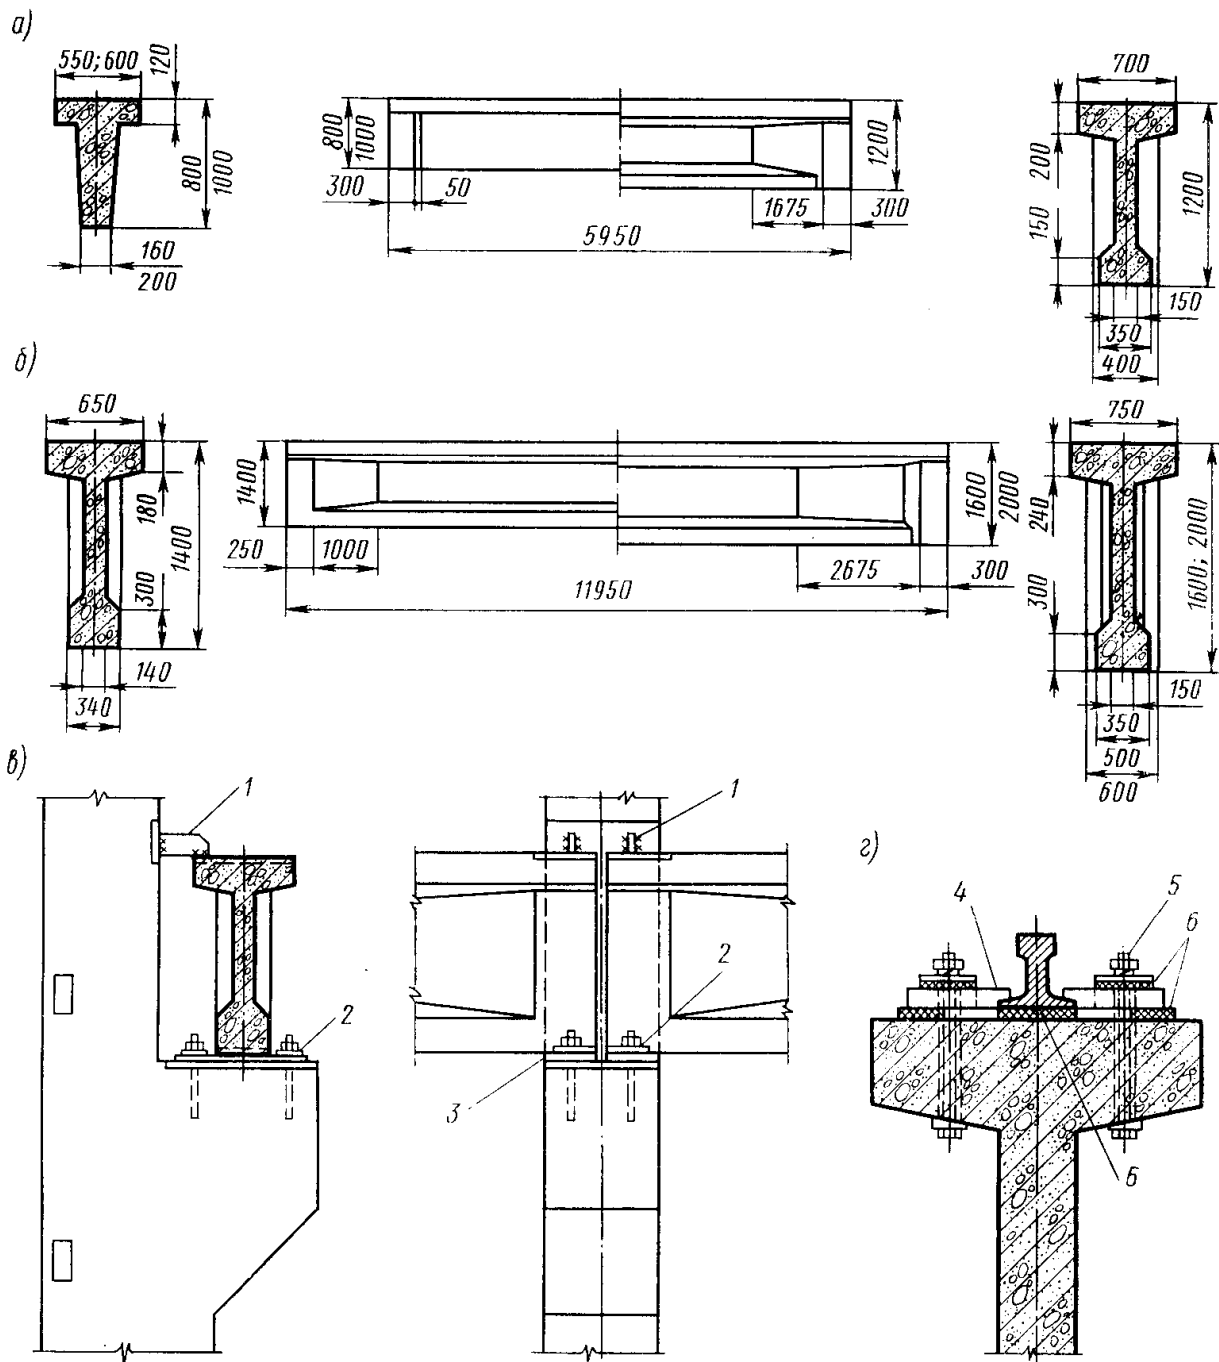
Схеми заліаобетонних пікранових балок:
